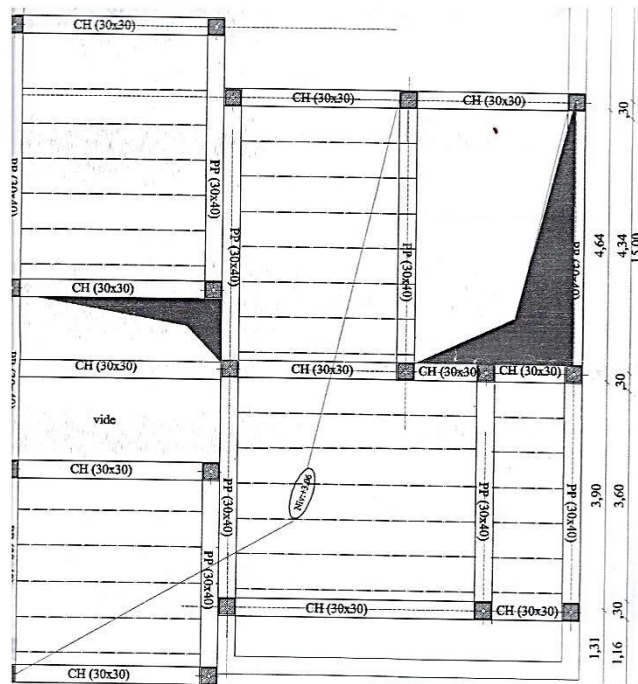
Plan de structure : Plancher du Niveau 1
